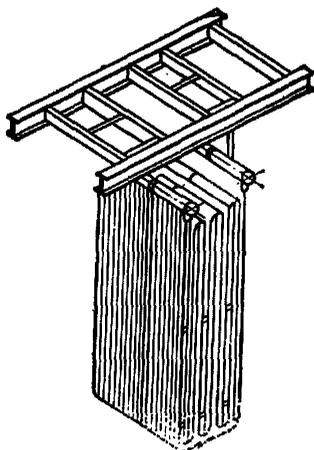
Укрупнительная сборка блока конвективной поверхности нагрева с вертикальным расположением змеевиков
